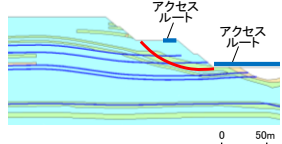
解析モデル図 (⑩-⑩' 断面)
